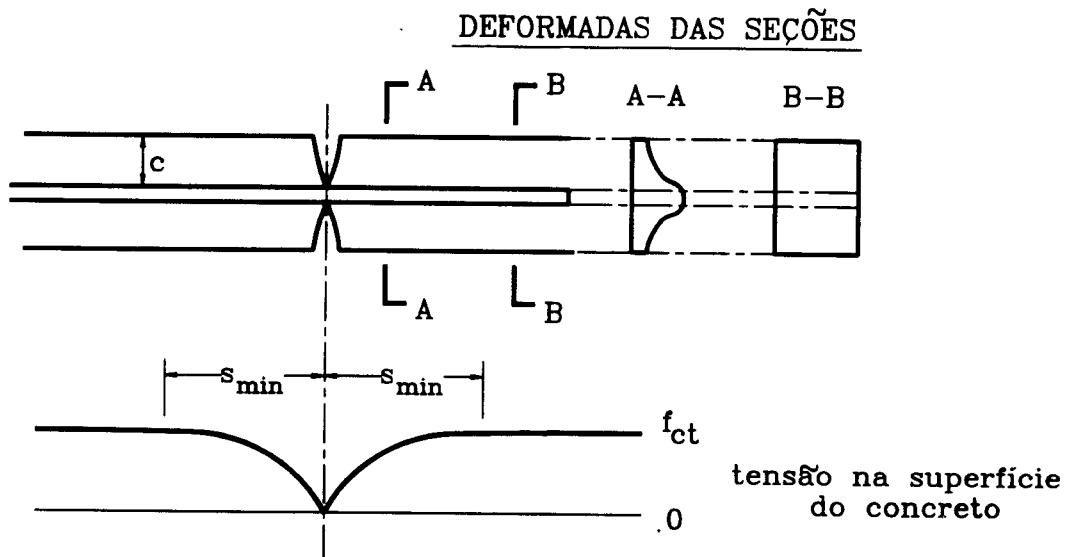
Mecanismo da fissuração segundo a teoria clássica do não-deslizamento
